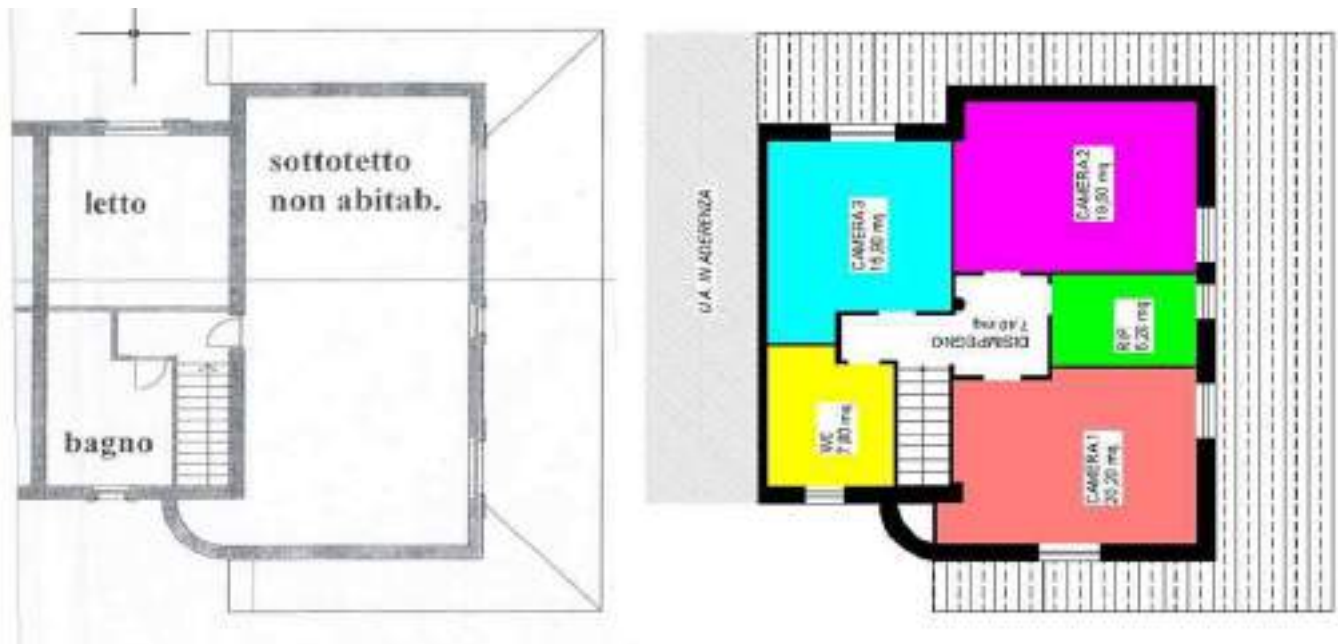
Sovrapposizione tra lo stato di fatto e il progetto assentito – Piano sottotetto
